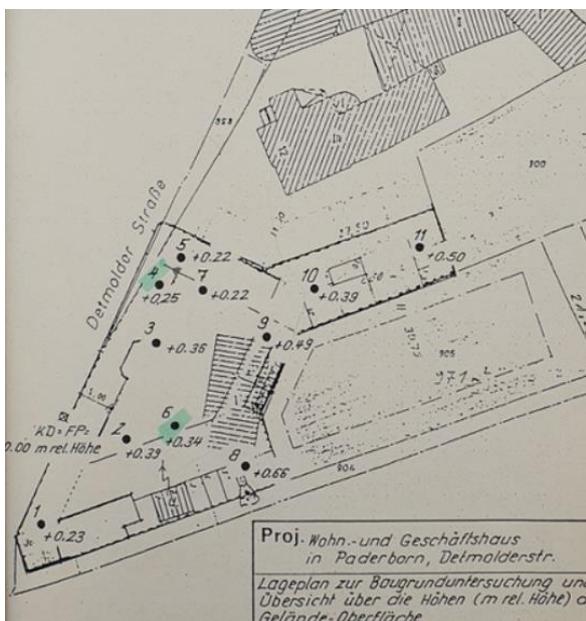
Lageplan Tankstellenbetrieb Detmolder Straße 8
